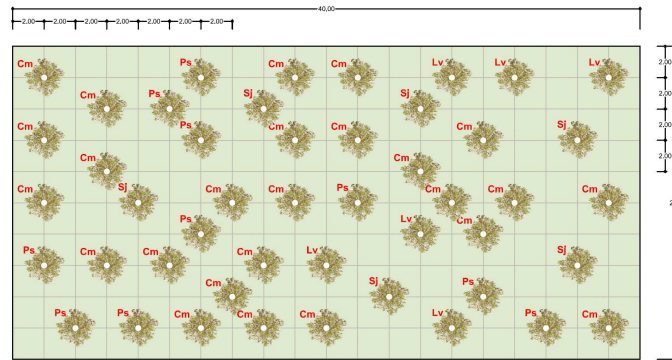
Stralcio planimetrico delle opere di mitigazione ambientale
